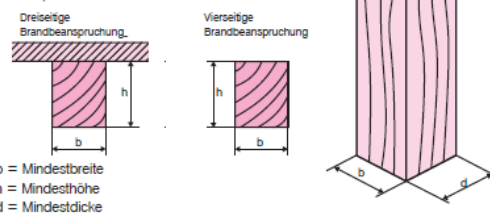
brandschutztechnische Dimensionierung von Holzbauteilen
